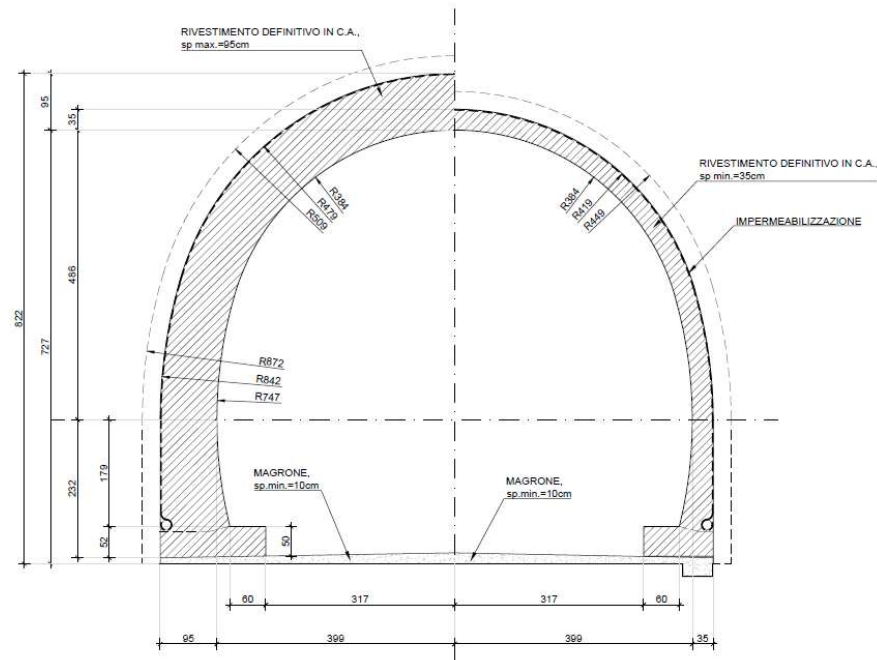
Carpenteria del rivestimento definitivo: a) carpenteria per geometria di supporti di prima fase B, C2 e C3; b) carpenteria per geometria di supporti di prima fase F1.
